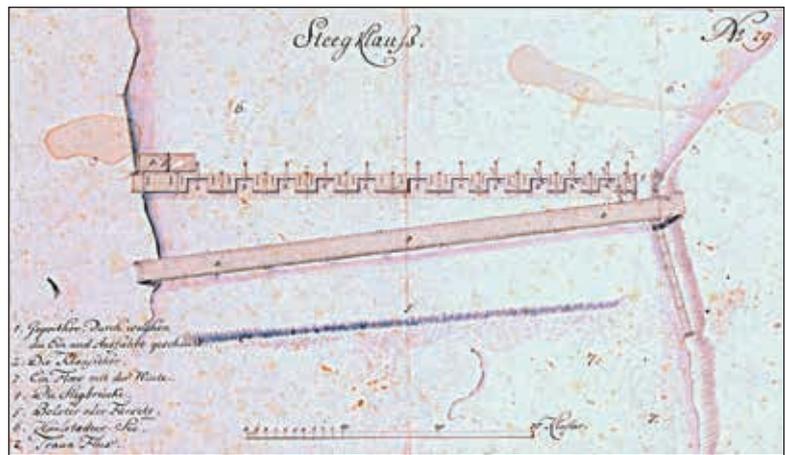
Plan der Seeklause mit Hallstätter See (oben) und Abfluss in die Traun (unten), (© Oberösterreichisches Landesarchiv)
